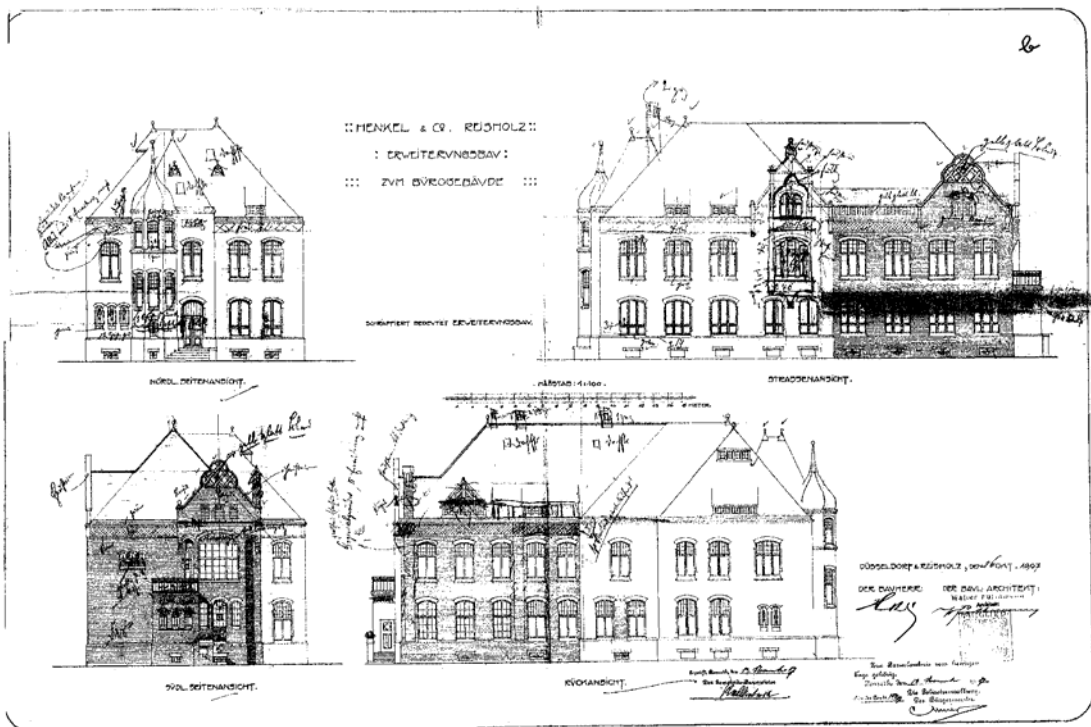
Verwaltungsbau - Ansichten, bauliche Erweiterung 1907 – Architekt: Walter Furthmann
